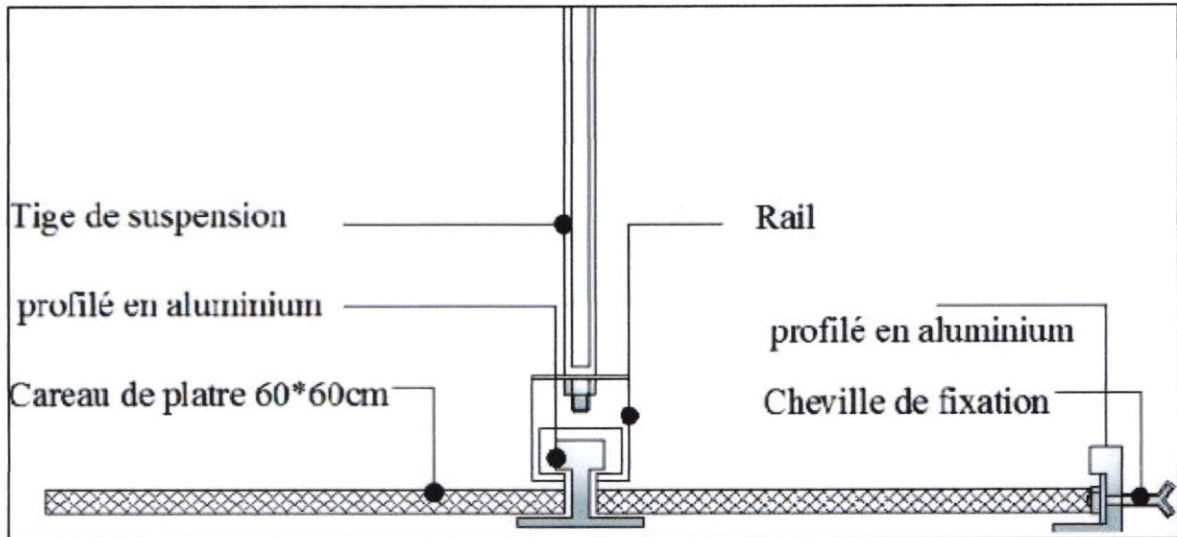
détail de fixation des faux plafond (coupe 1/20); source : <http://www.knauf.ch/fr/assortiment/plafonds/systemes/knauf-plattendecken.html>
